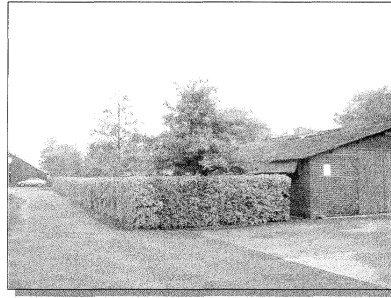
Gezamenlijke inrit en te slopen kuikenstal.
